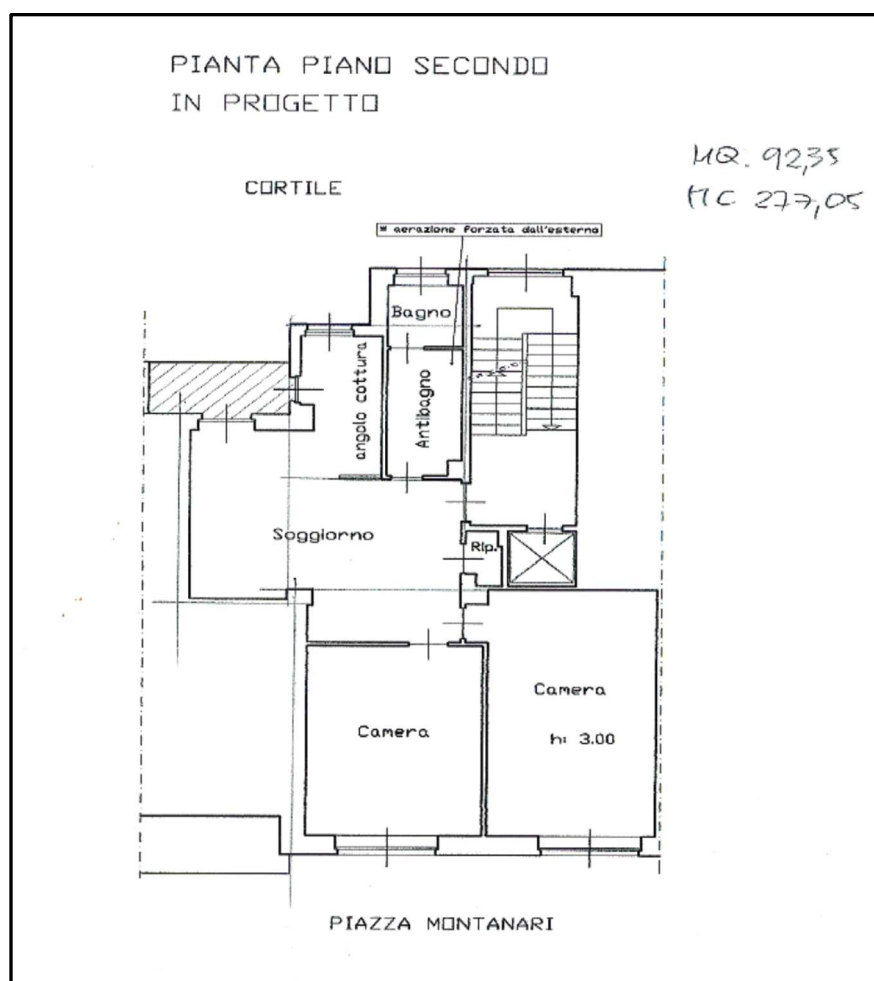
Estratto planimetria piano secondo (3° p.f.t.) DIA 2005 9 2524
